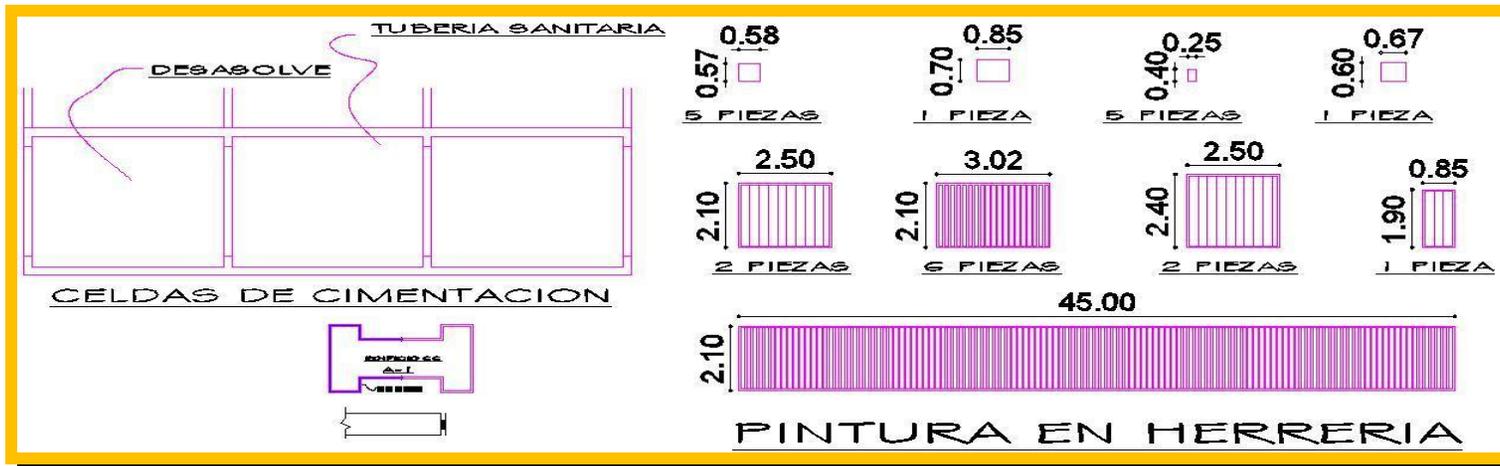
Proyecto de desazolve de celdas de cimentación y pintura de herrería
